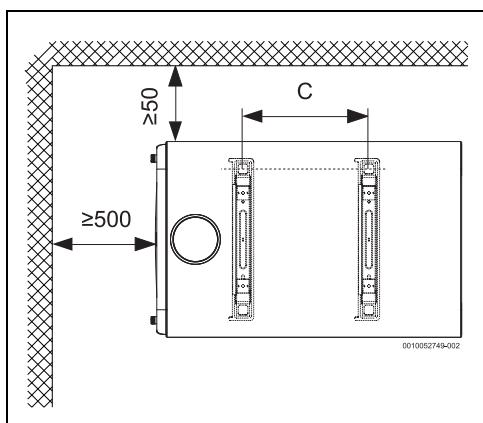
Dimensions en mm (montage mural, installation verticale)
